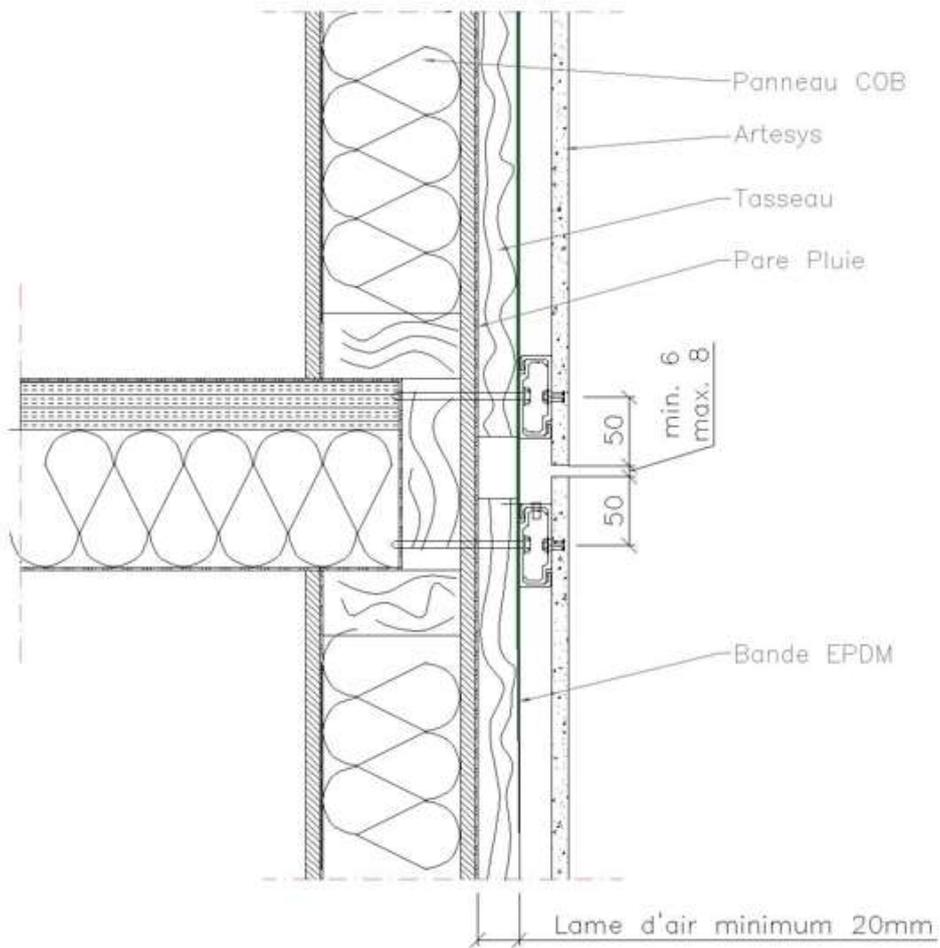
Pose sur COB - Recouvrement ossature au droit d'un plancher
